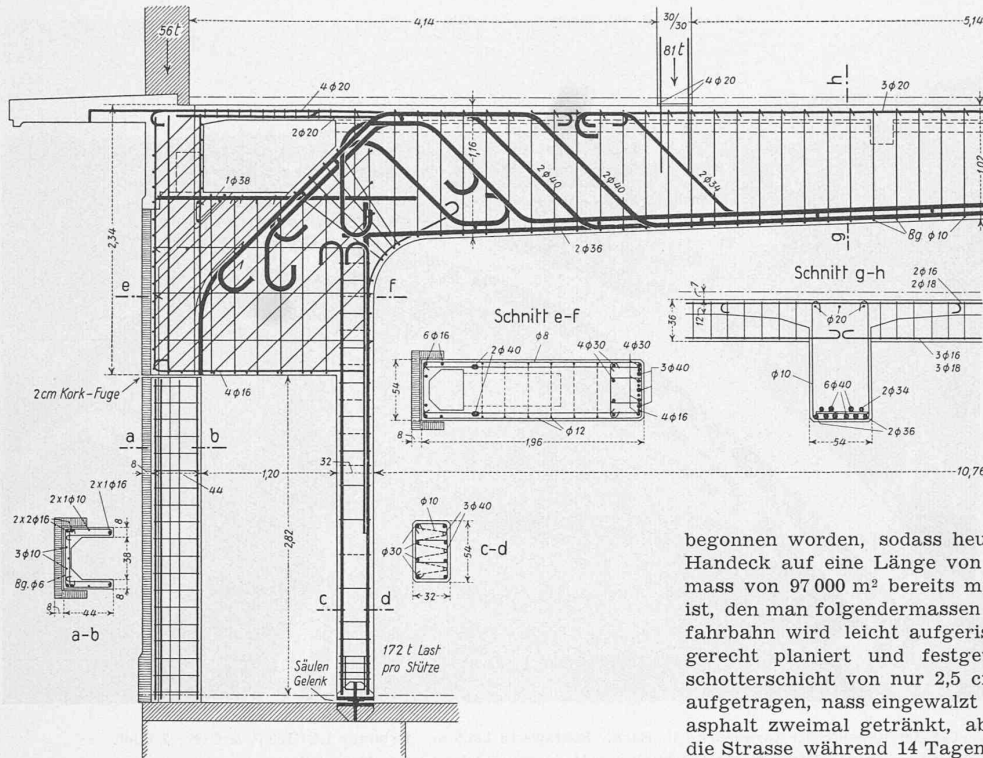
Eisenbeton-Binder im Erdgeschoss, 1:60.
